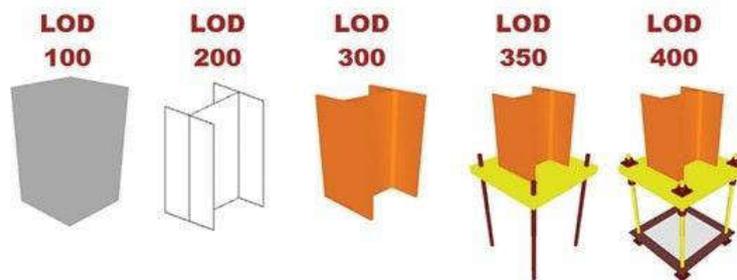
LOD Floor Structural Frame (Steel Framing Columns)
